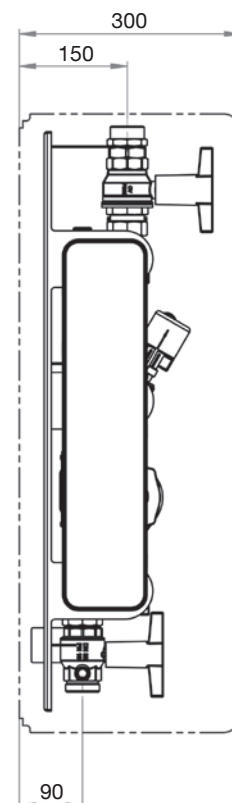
Dimensiones “Regumaq X-80” (lado)
